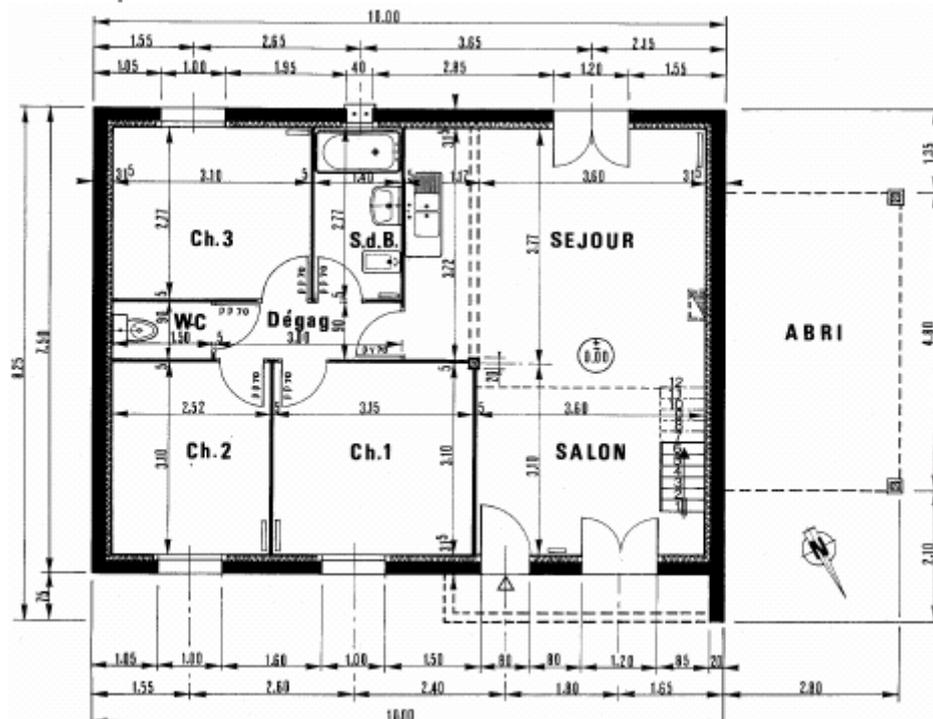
PLAN DU REZ-DE-CHAUSSEE
